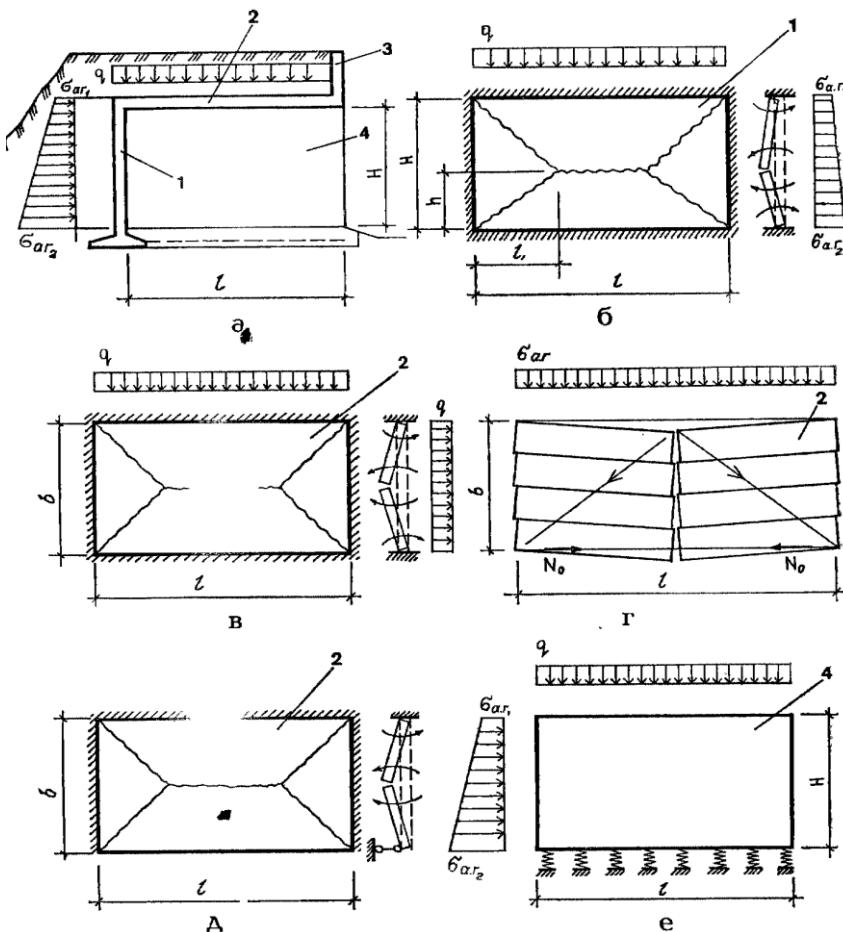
Розрахункові схеми елементів обвалованих житлових будинків: а – обвалованої стіни, б – покриття; в – збірного перекриття; г – покриття з шарнірною опорою; д – внутрішньої стіни; е – внутрішньої стіни; 1, 4 – стіни – власне обвалована і внутрішня; 2 – покриття, 3 – парпет
